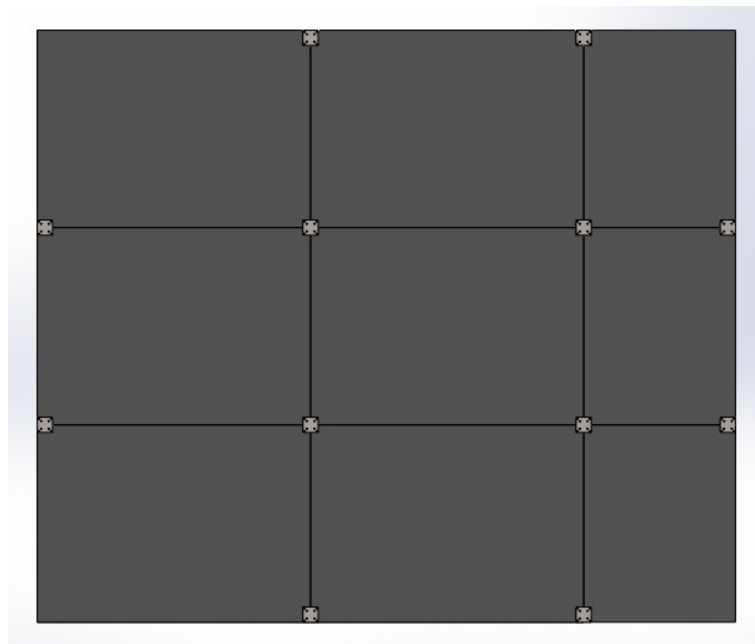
Armado del piso del planetario mediante planchuelas en cada esquina.
